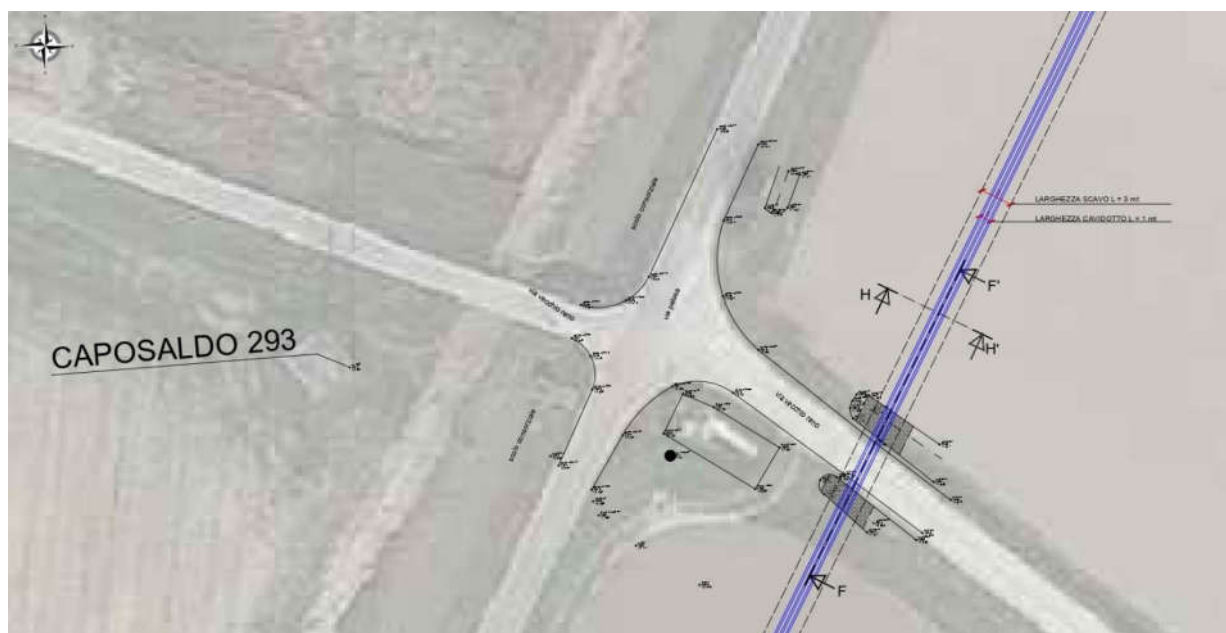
Tratto F-F' - Rilievo planoaltimetrico post-intervento
